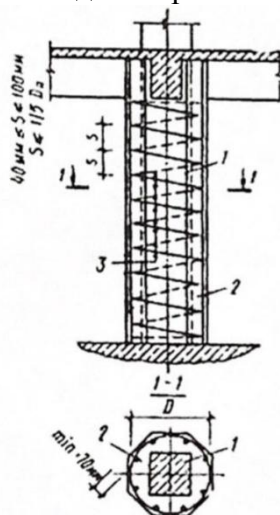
Усиление колонны обоймой со спиральной арматурой:
